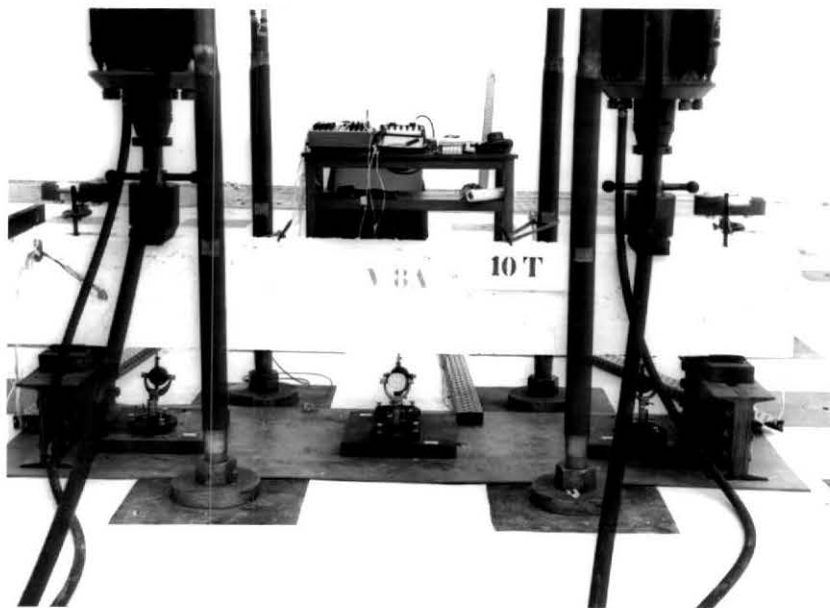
Vista geral do ensaio da viga 8A ($a/d=0,8$).
